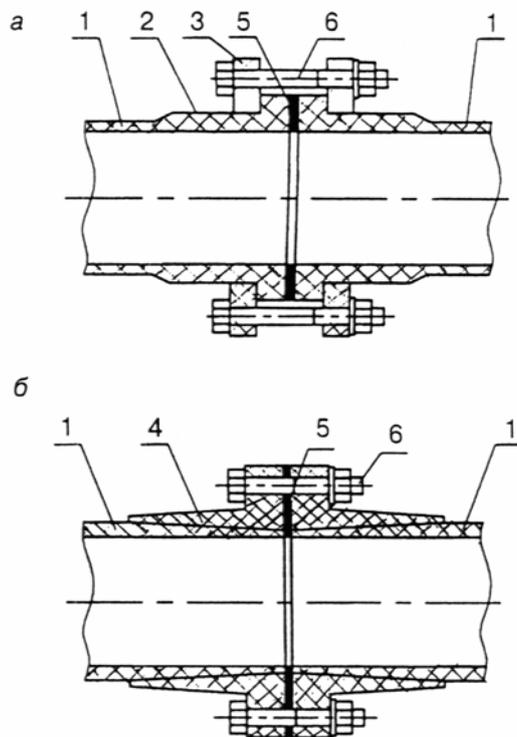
Схемы соединений стеклопластиковых труб на резиновых уплотнителях
